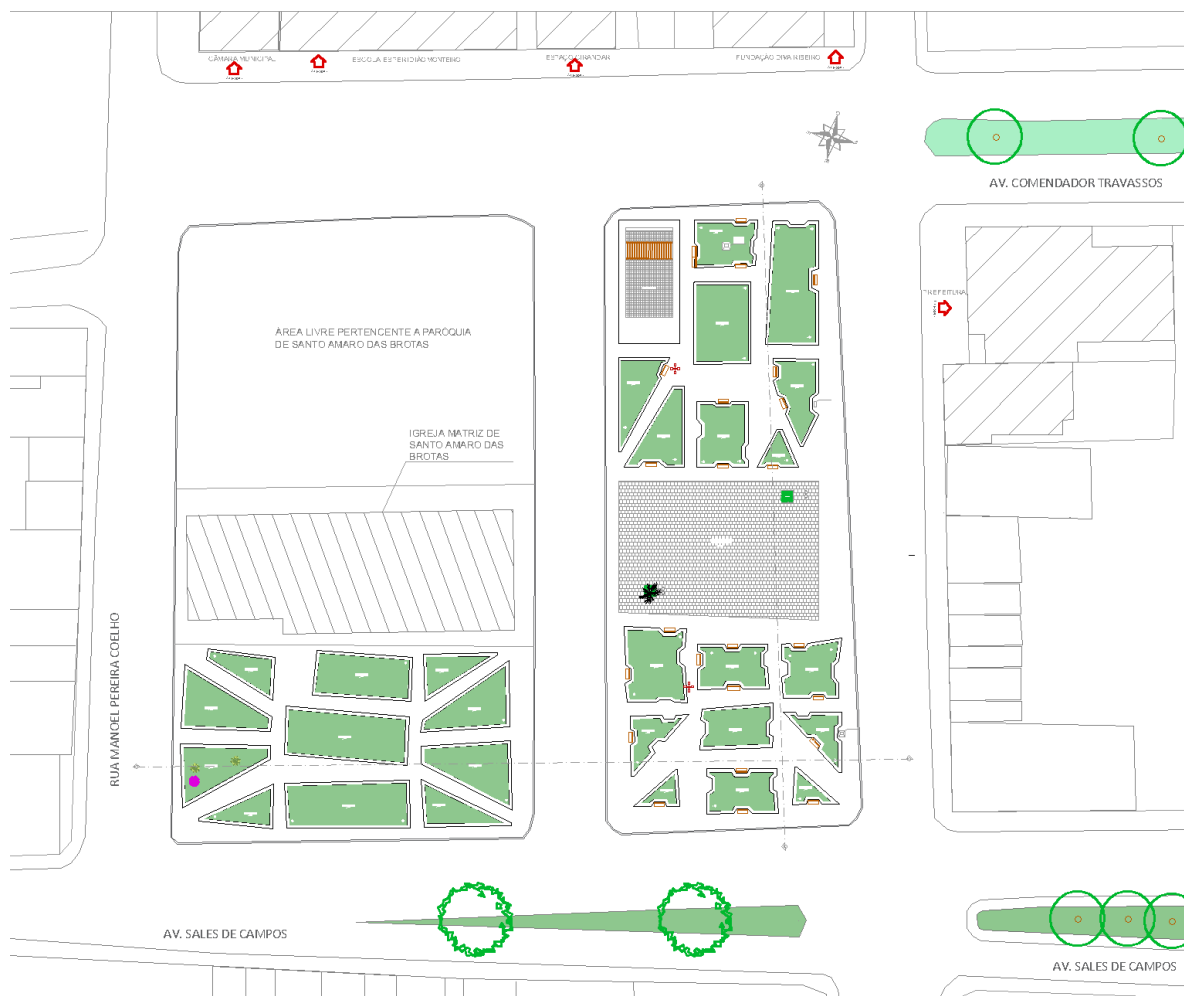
Layout atual da Praça Cel. Jacinto Ribeiro
